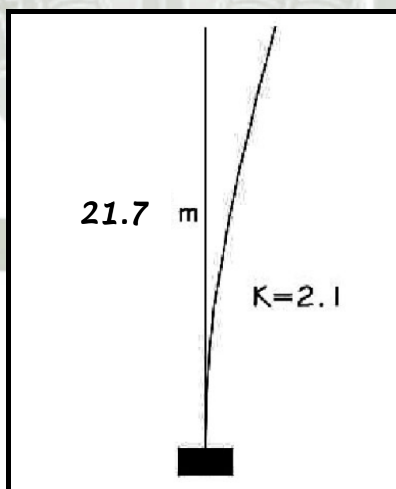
Factor de Longitud Efectiva “K” en el Plano Transversal al Pórtico,
